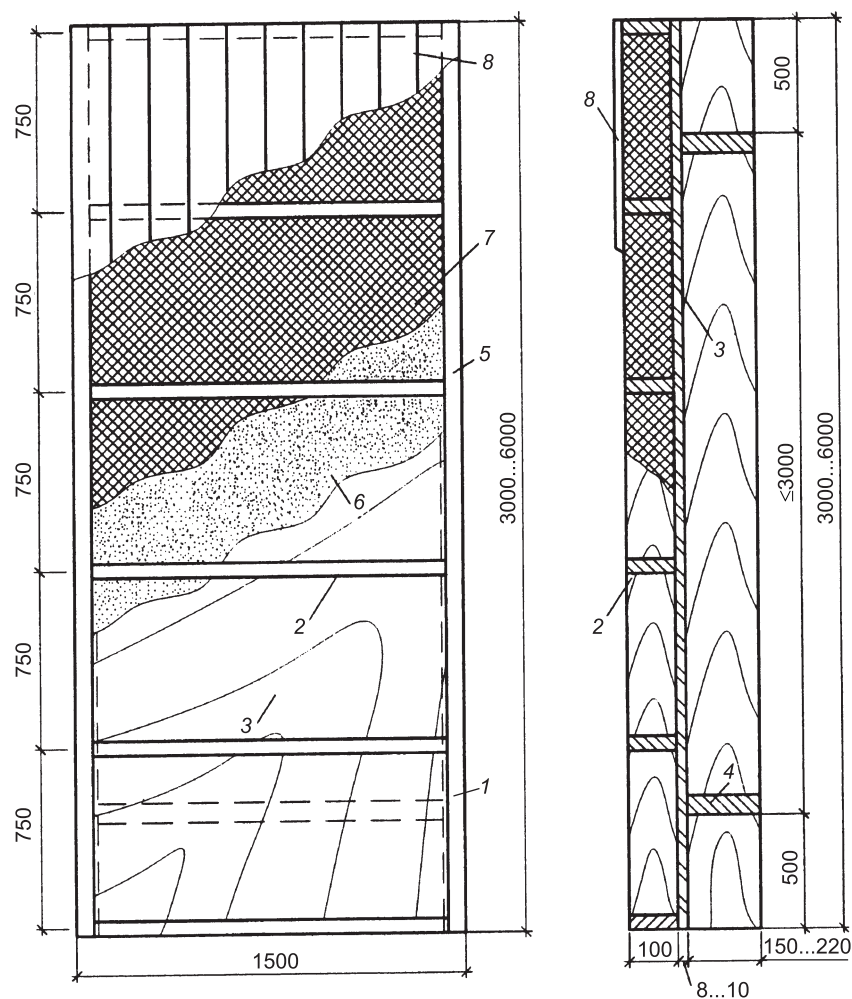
Вариант конструкции совмещенной стеновой панели с фанерной обшивкой
